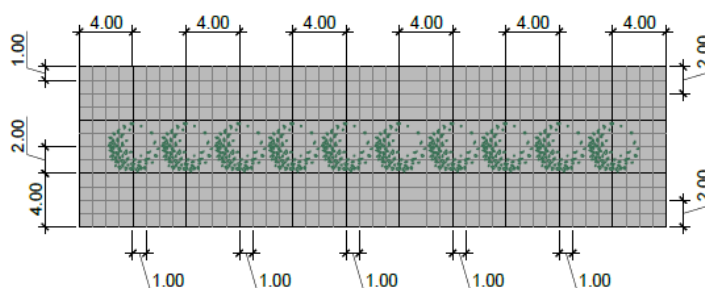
Estratto elaborato IF1N.01.E.ZZ.PZ.IA00.0.0.006 - Planimetria localizzazione interventi di mitigazione (Tav. 6 di 6)
